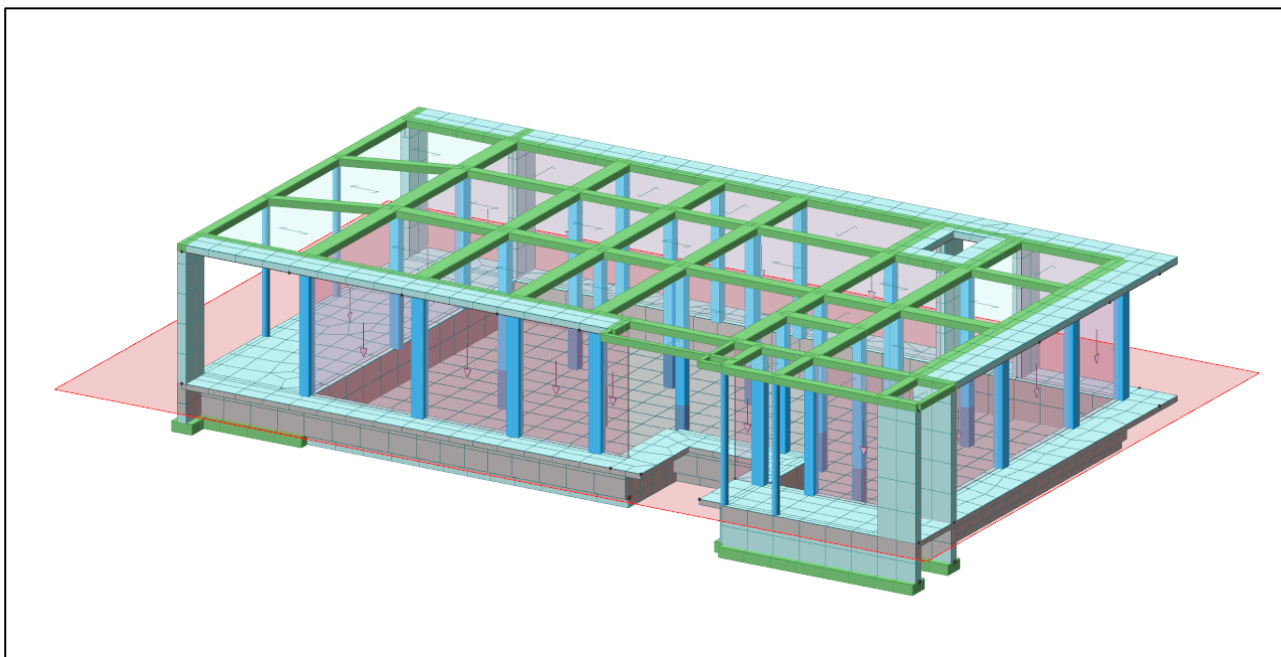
Vista 3D telaio in c.a. ModeSt ver. 8.34
